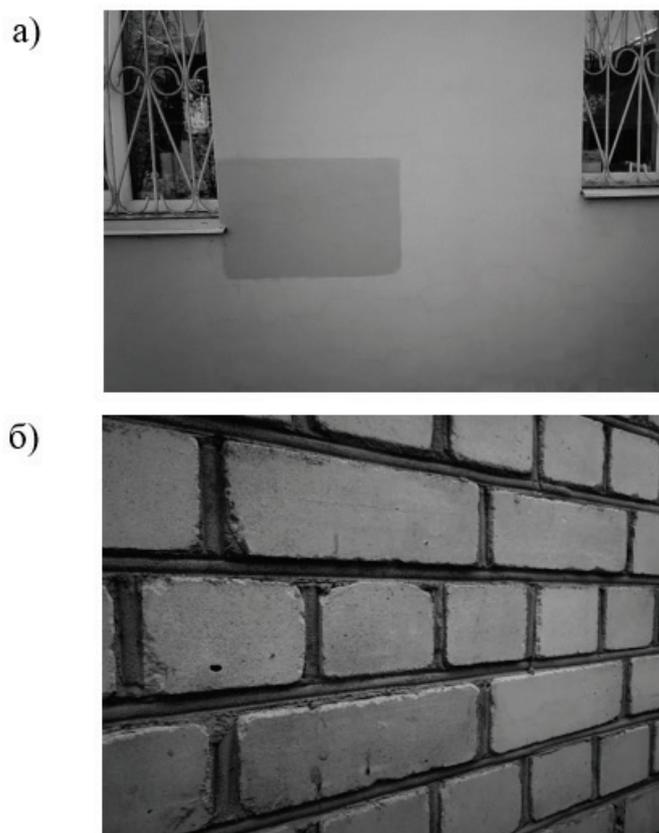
Отметки на исследуемых участках стен: а) оштукатуренный и покрытой краской фасад, б) кирпичная кладка
